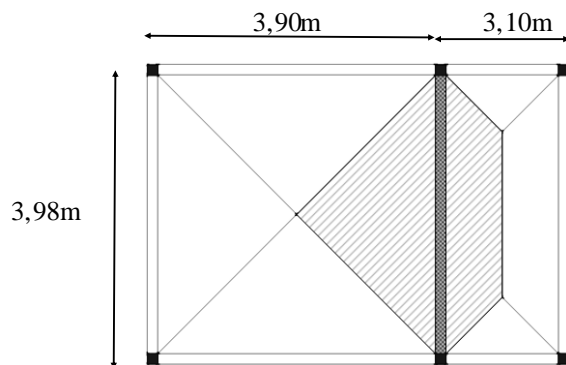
La transmission des charges du panneau de plancher sur une poutre.
